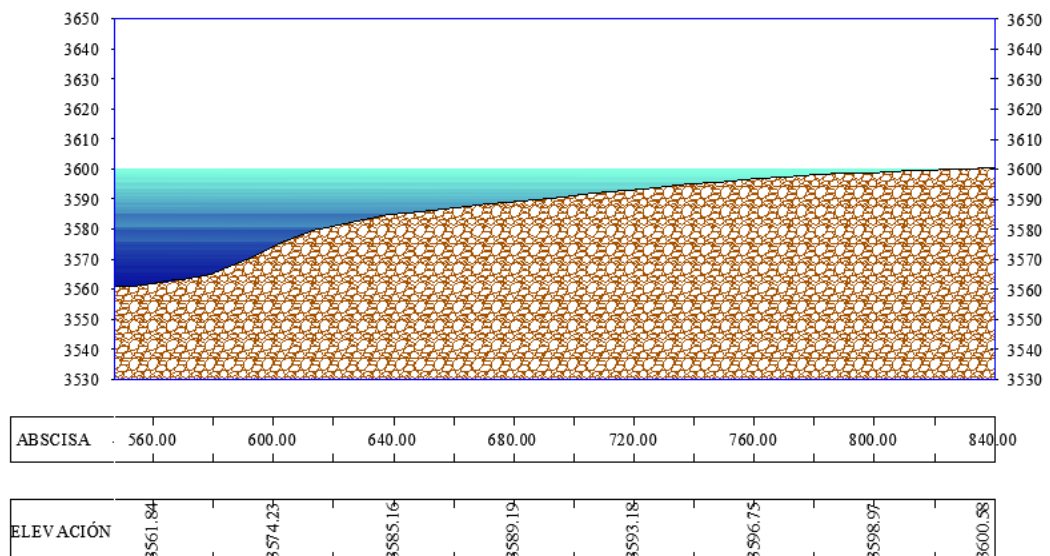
Perfil Transversal (Abscisa 560 a 840) - Área de corte para el punto 3 (Río Pita)
